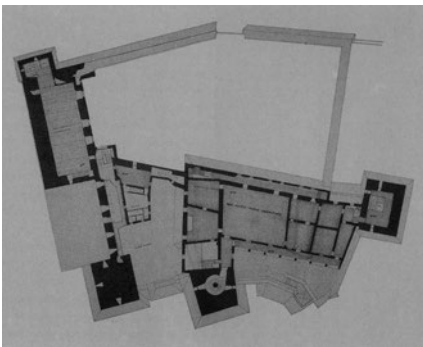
Planimetria del progetto di restauro del Castel Sismondo (in alto).
